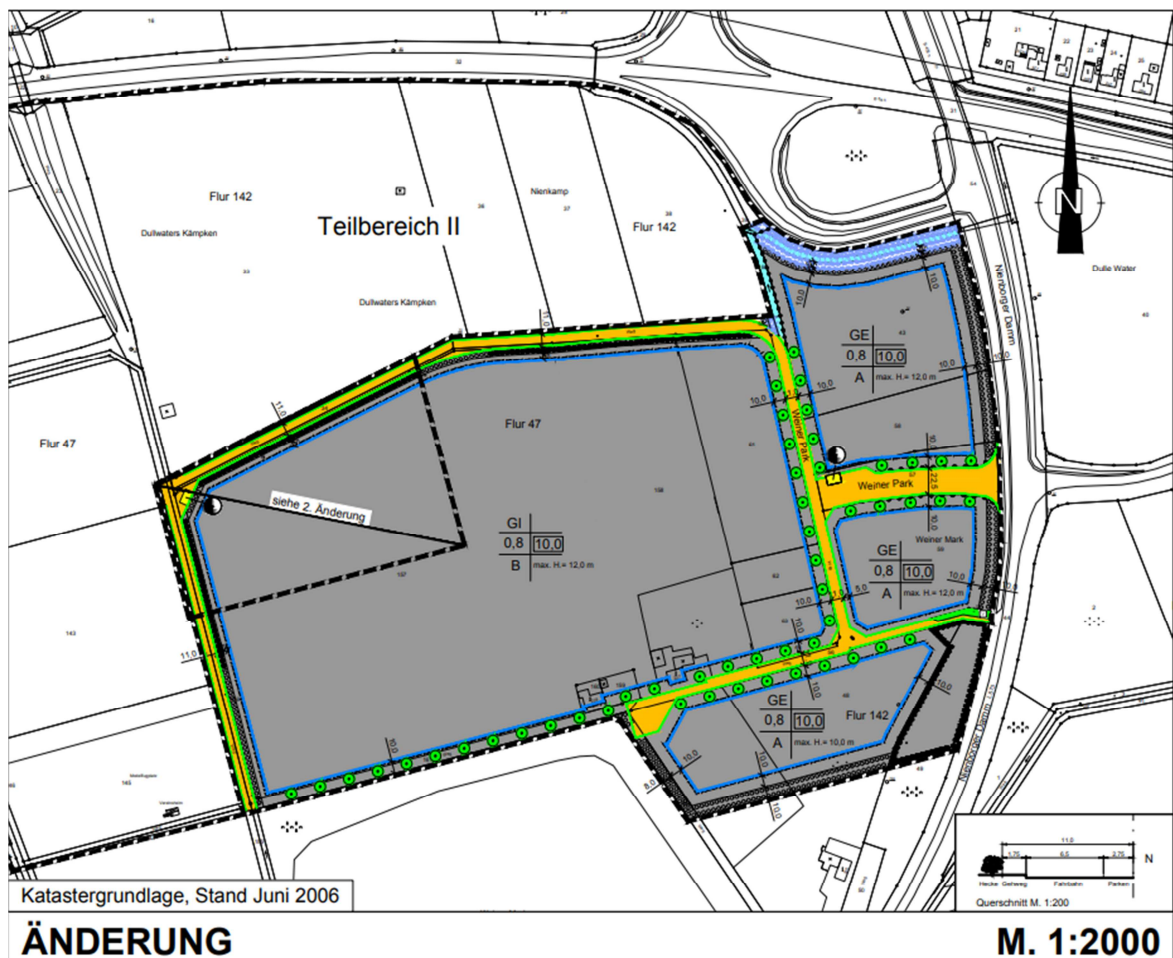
Ausschnitt Bebauungsplan Nr.79, TB I, vereinfachte Änderung „Gewerbe- und Industriegebiet Weiner“ (Stadt Ochtrup 2007).
